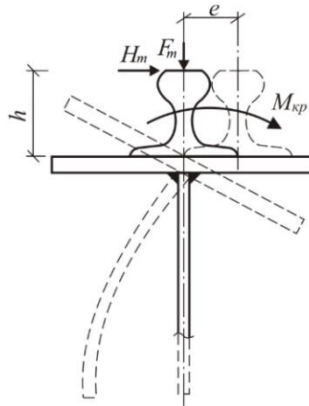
Схема дії вертикального та горизонтального навантажень на підкранову балку
